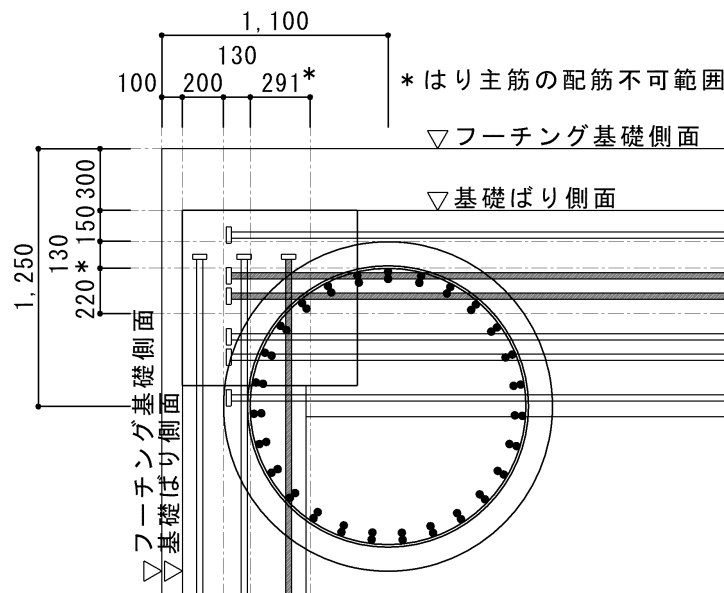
杭と基礎ばりの配筋図(断面図の配筋を示す)
